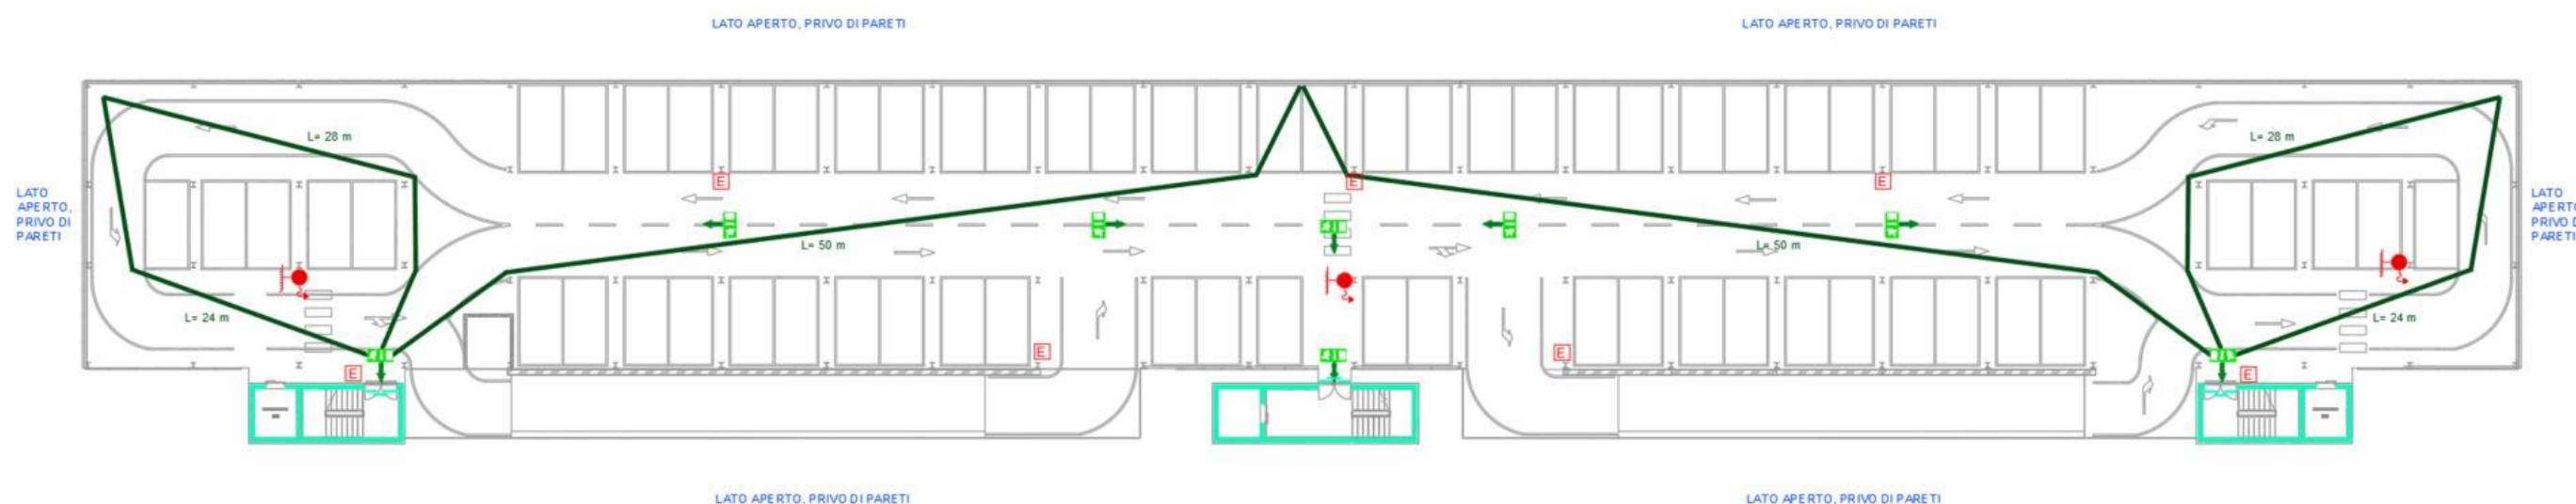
Pianta Piano Primo Parcheggio via Saliceto
